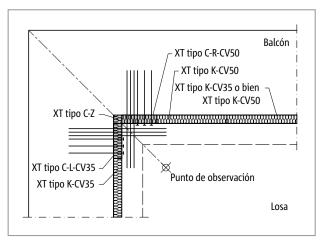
Schöck Isokorb® XT tipo C: Balcón en voladizo con esquinero externo (utilización de XT tipo C-L-CV35, XT tipo C-R-CV50)
